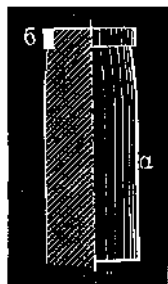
Кольцо-бугель, насаженное на сваю, вѣсомъ 6—15 фунтовъ: а—свая, б—бугель.
